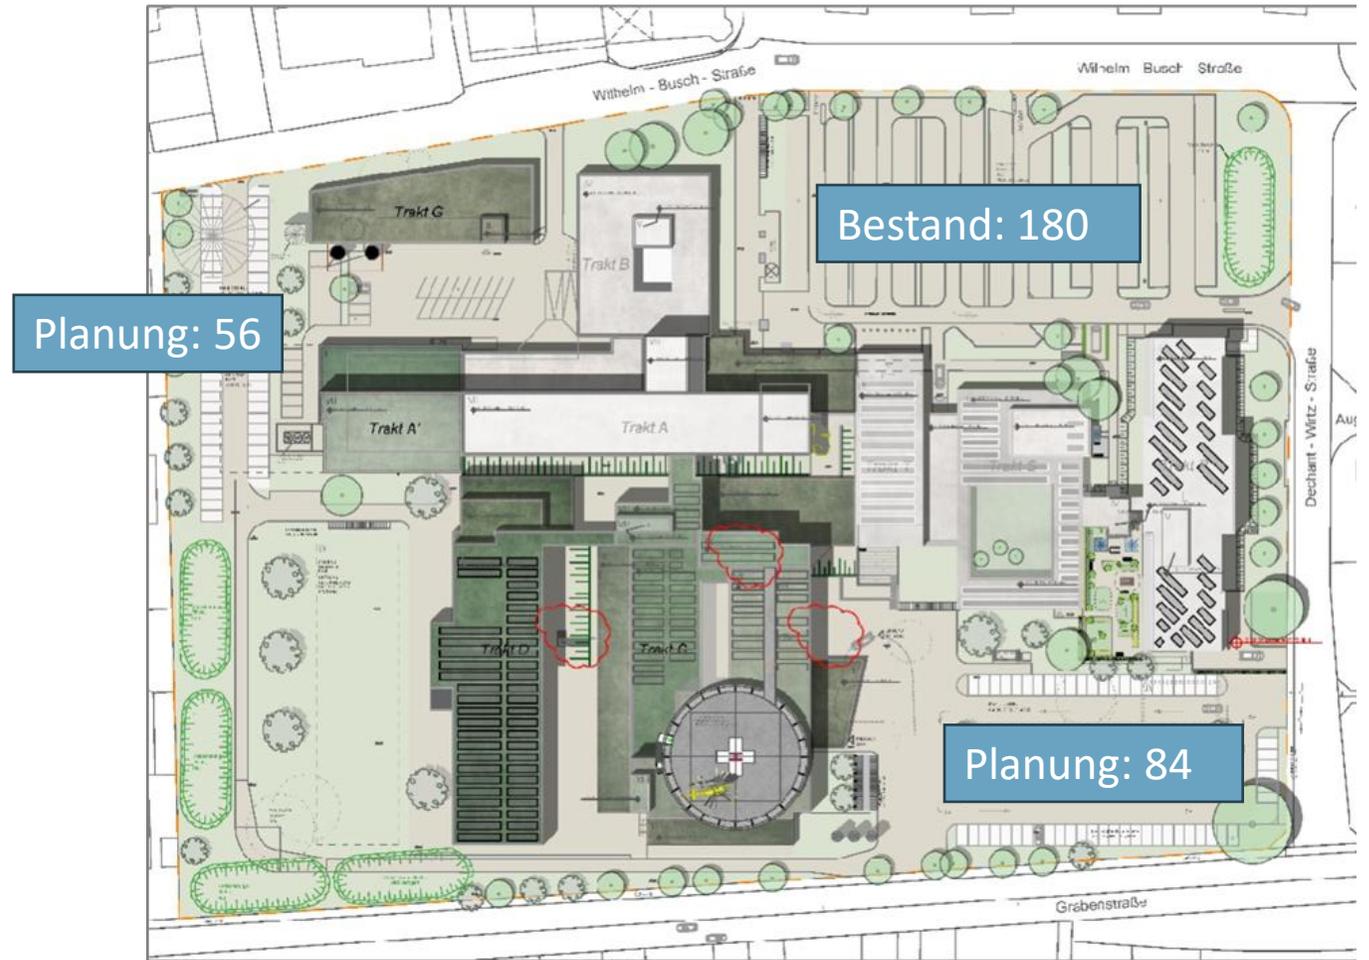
Lageplan des Bauvorhabens (Quelle: Architekten Beckmann)
